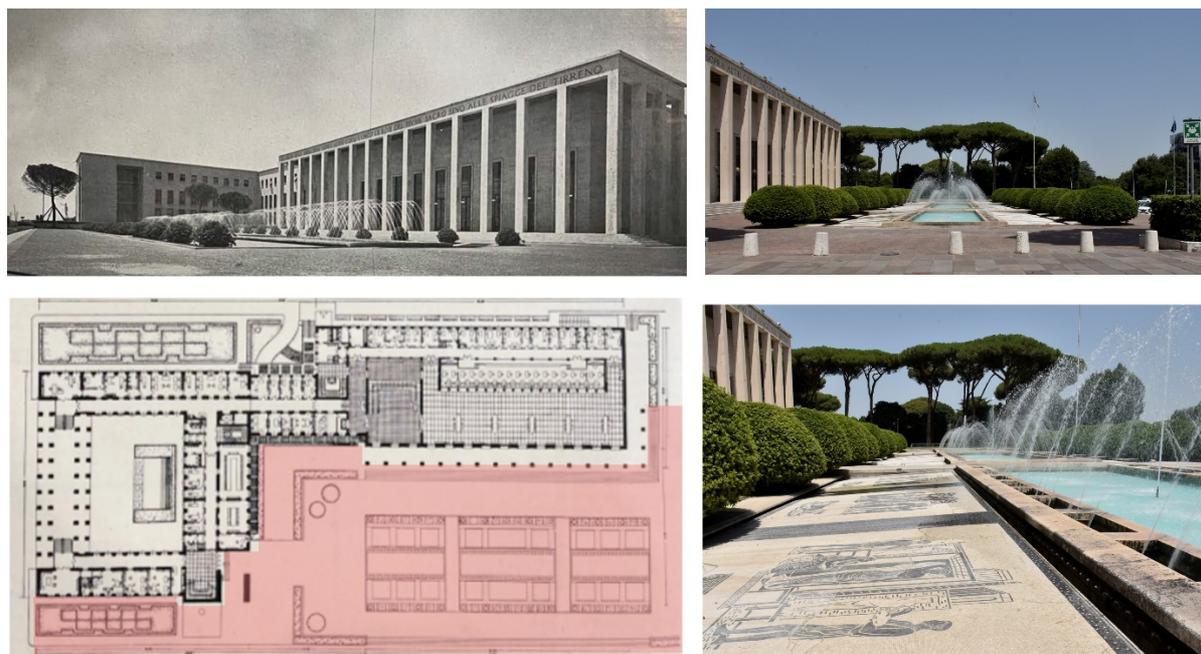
Palazzo degli Uffici all'Eur. A sinistra: veduta e planimetria del progetto (Pagano e Minnuci 1940, pp. 5 e 22) con indicazione dell'area di studio. A destra foto attuali.
